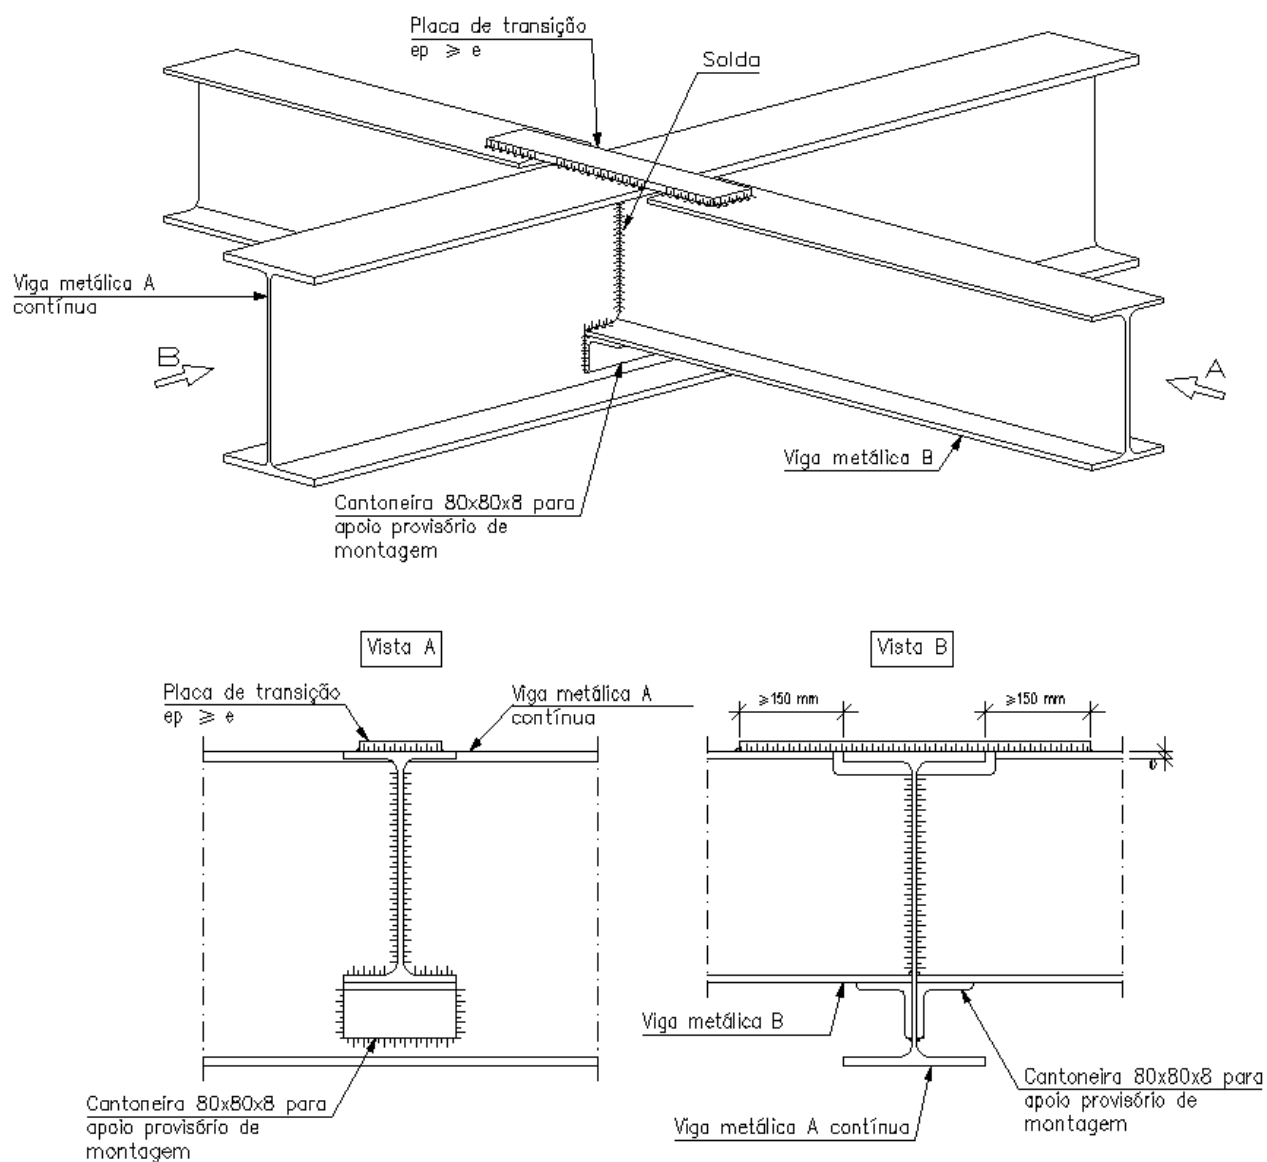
Ligação em cruz, com continuidade entre vigas metálicas de mesma altura, com torção
